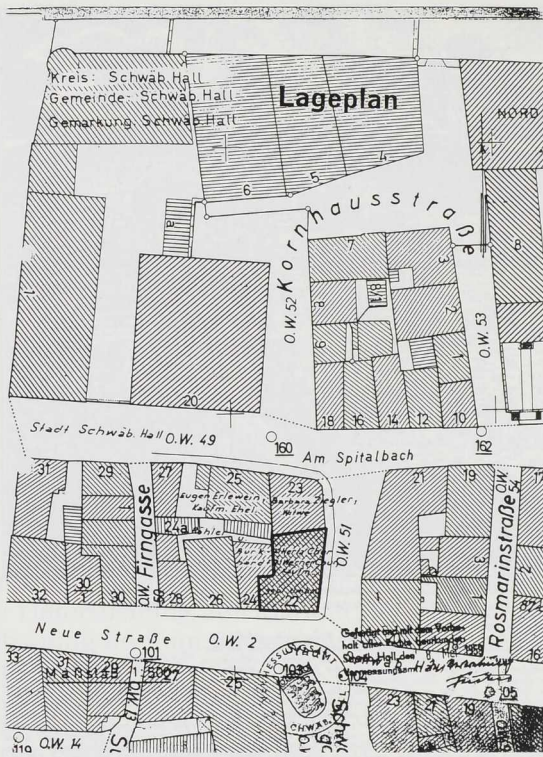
Schwäbisch Hall, Neue Straße 22, Lageplan Haus Chur.
